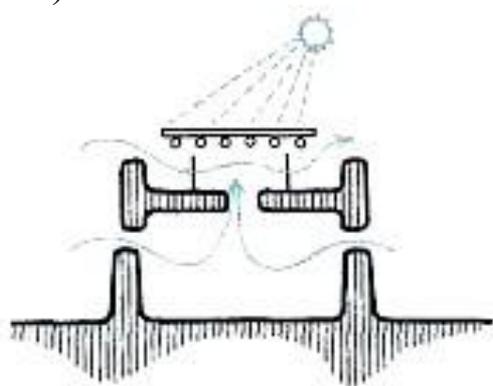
Устройство естественной вентиляции. Разрез здания. (Ближний Восток).
